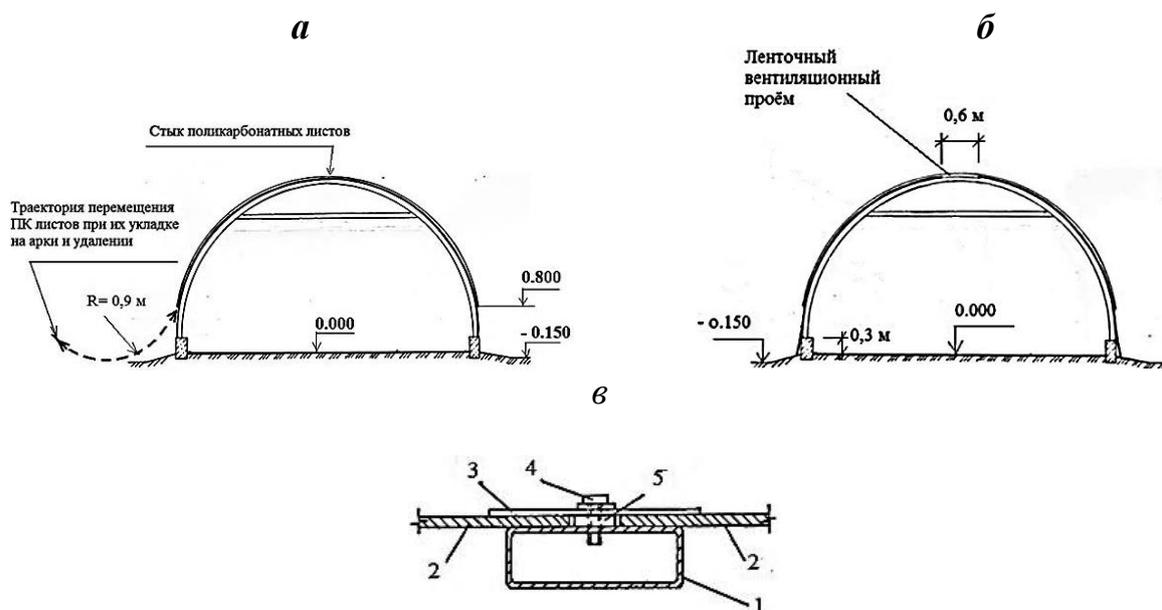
Разработанное решение сезонной теплицы с выдвигаемыми кровельными листами: *а* – схема монтажа и демонтажа кровельных листов; *б* – схема образования вентиляционного проёма; *в* – деталь кровли: 1 – стальная арка каркаса теплицы; 2 – сотовый поликарбонатный лист; 3 – нащельник из монолитного поликарбоната; 4 – саморез; 5 – шайба
